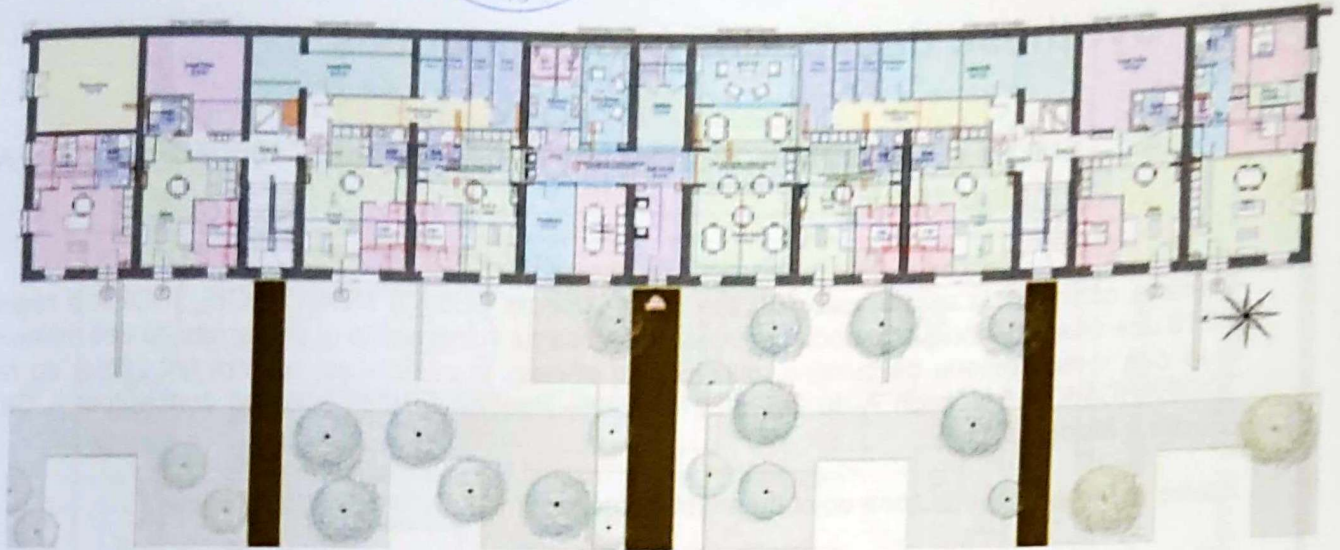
Plan masse du projet d'aménagement (Source : NEXITY – sans échelle)
